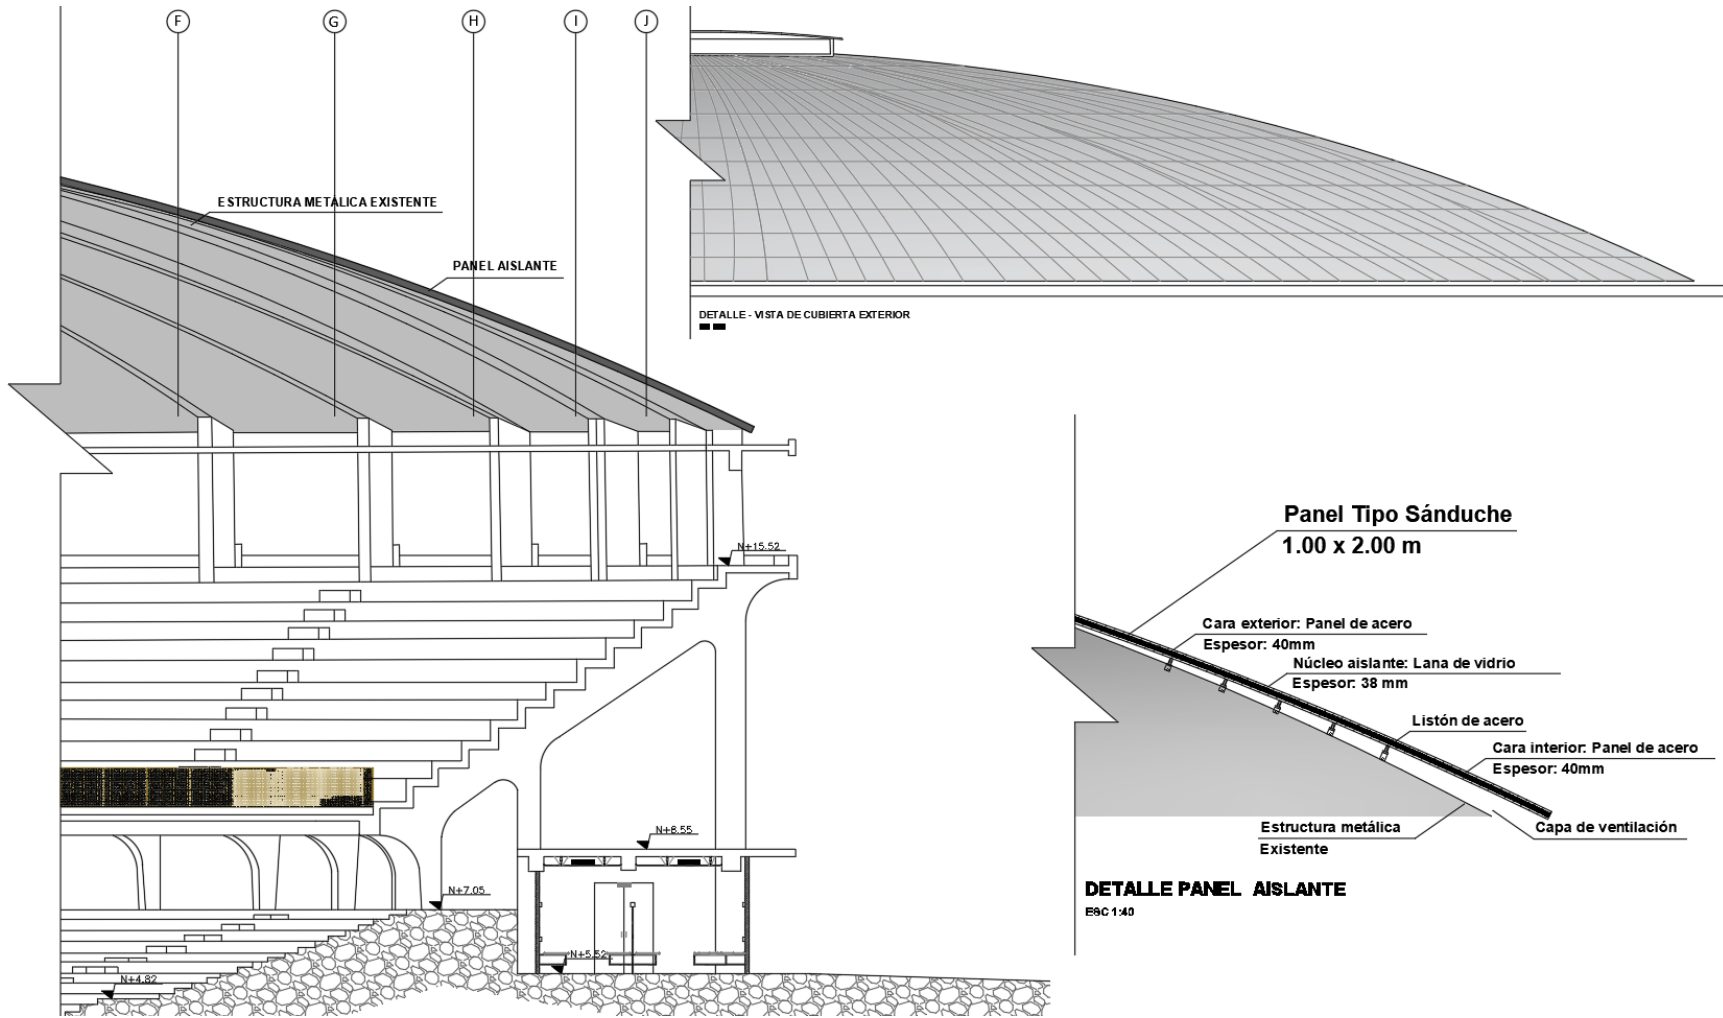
Detalle de cubierta. Fuente: Elaboración propia (2019).
